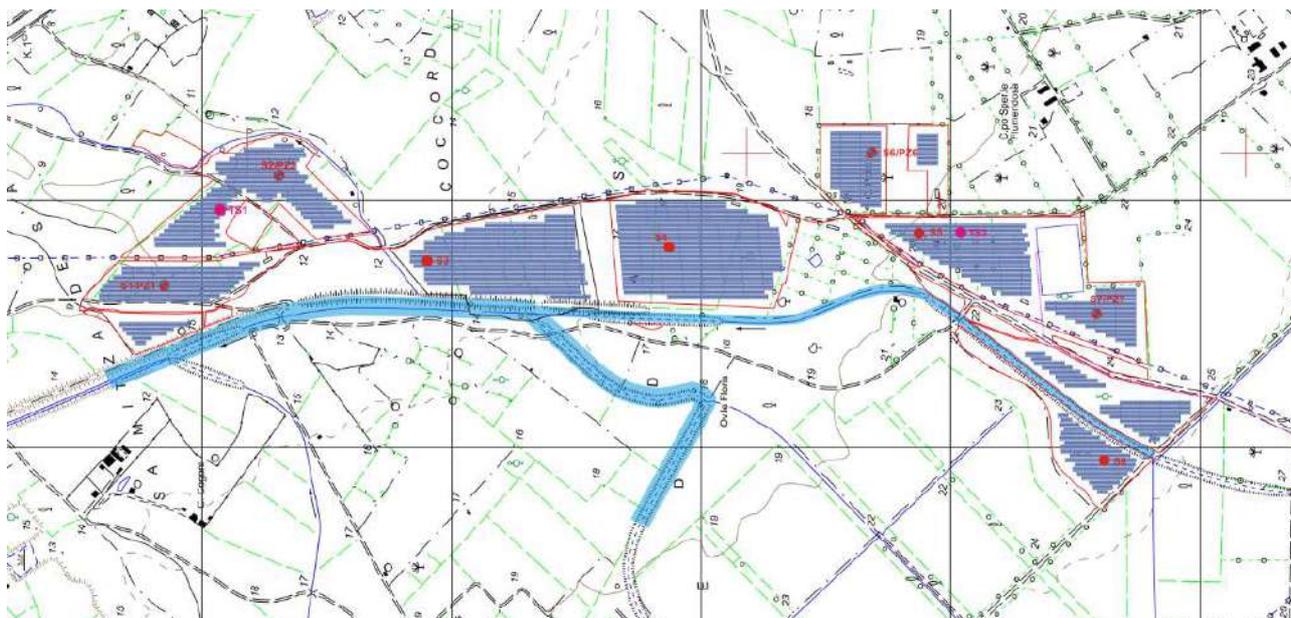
Planimetrica generale impianto fotovoltaico CACIP 25
